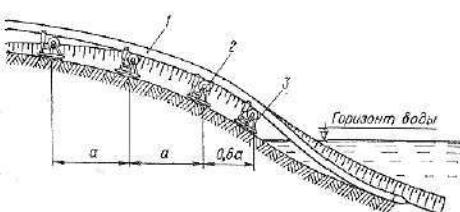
Схема роликовой дорожки для спуска трубопровода:
